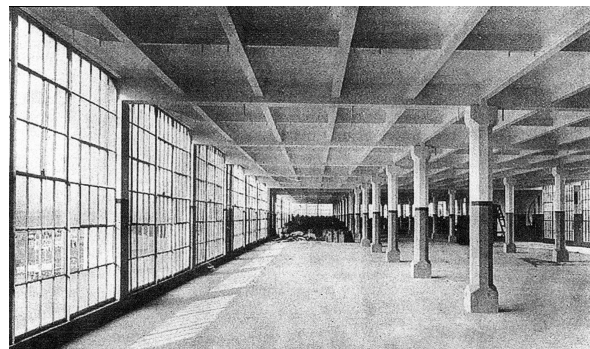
Innenansicht der Shoe Machinery Factory in Beverly, MA, 1905-07 aus: American Machinist 8 Juni 1907, S. 723.
